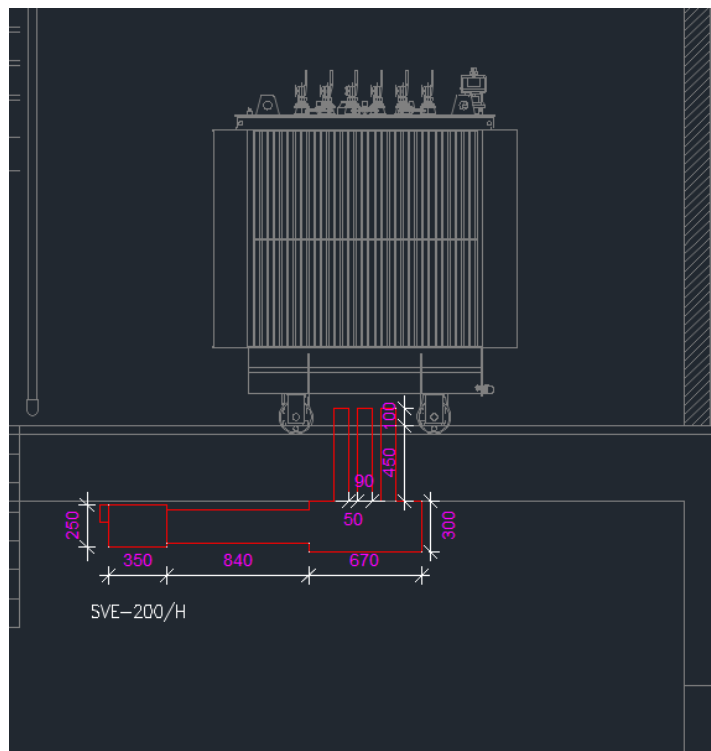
Peça desenhada do Ventilador e Caixa de ventilação
